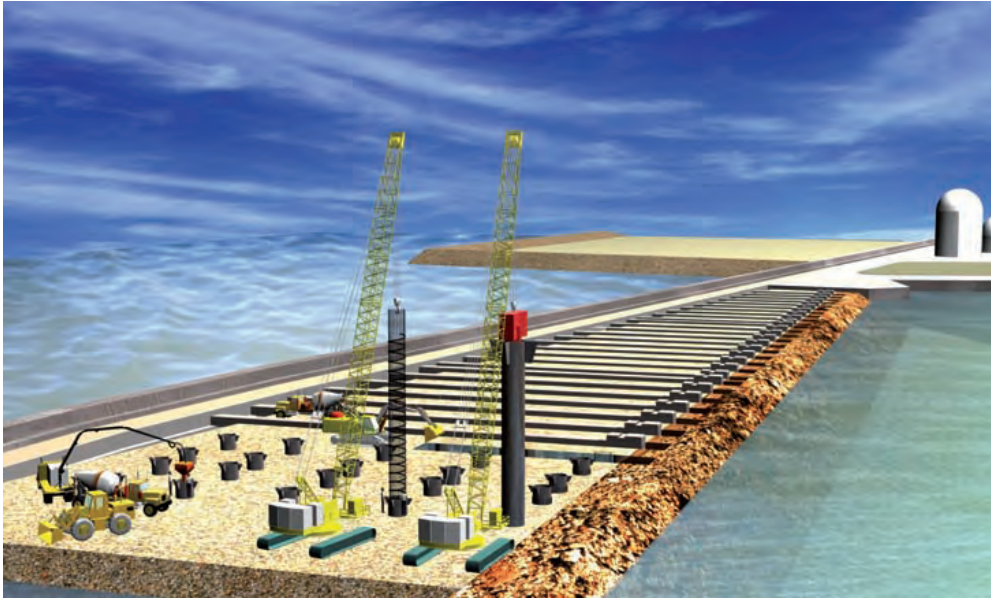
b A Secuencia constructiva muelle de pilotes
